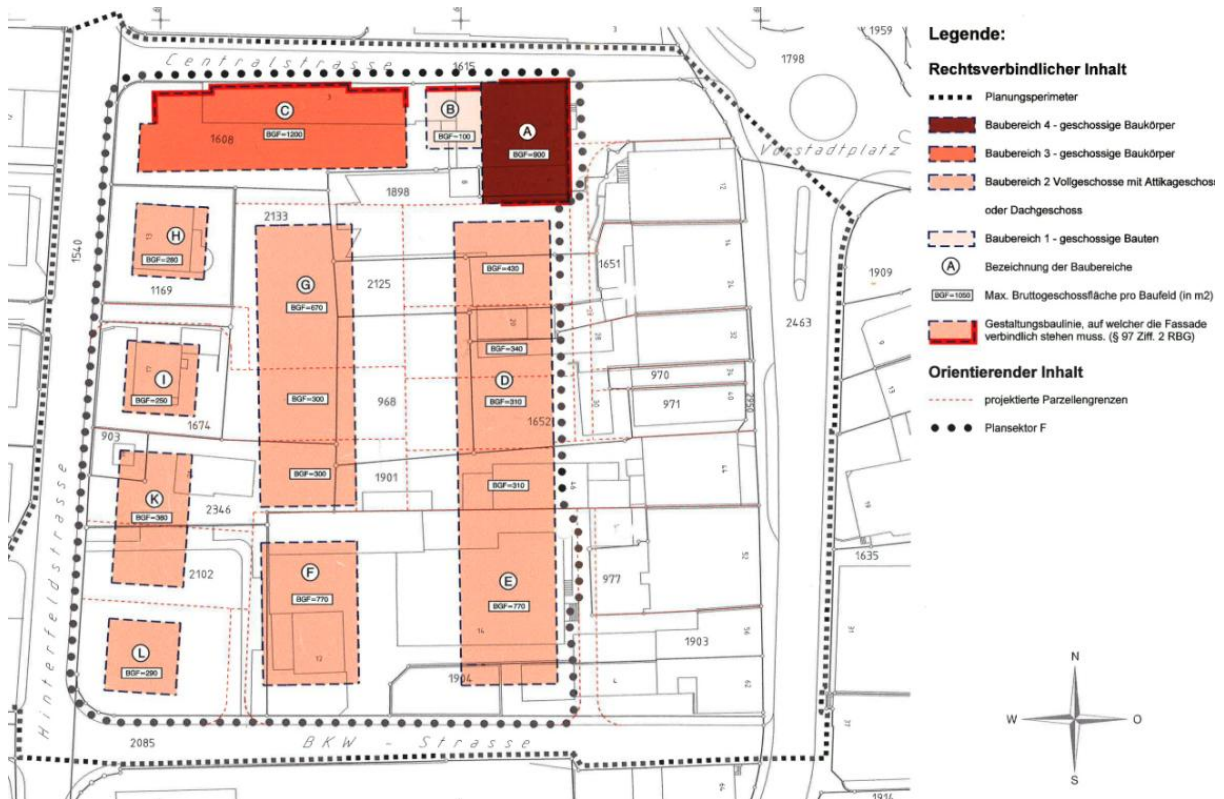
Alter Bestand (breite graue durchgehende Linien) mit überlagerten Baubereichen (rot)
